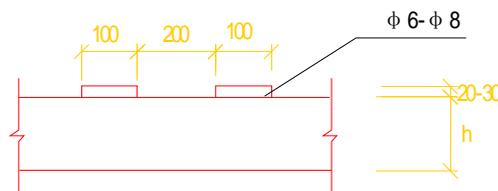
板肋、边梁伸出扁钢筋套
